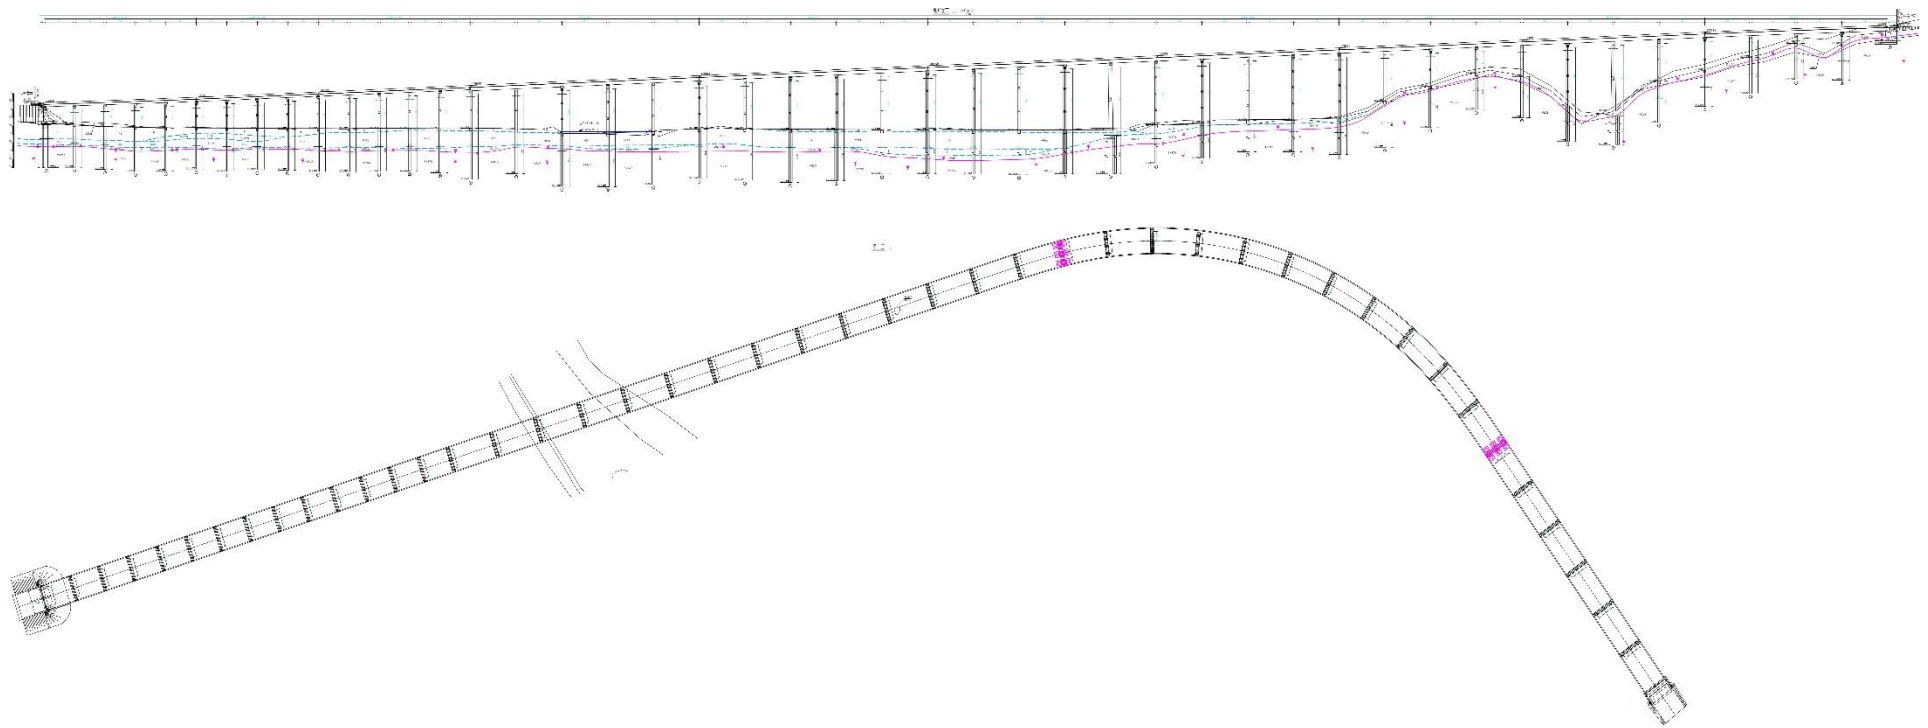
潜溪河特大桥桥梁纵断面图和平面图
